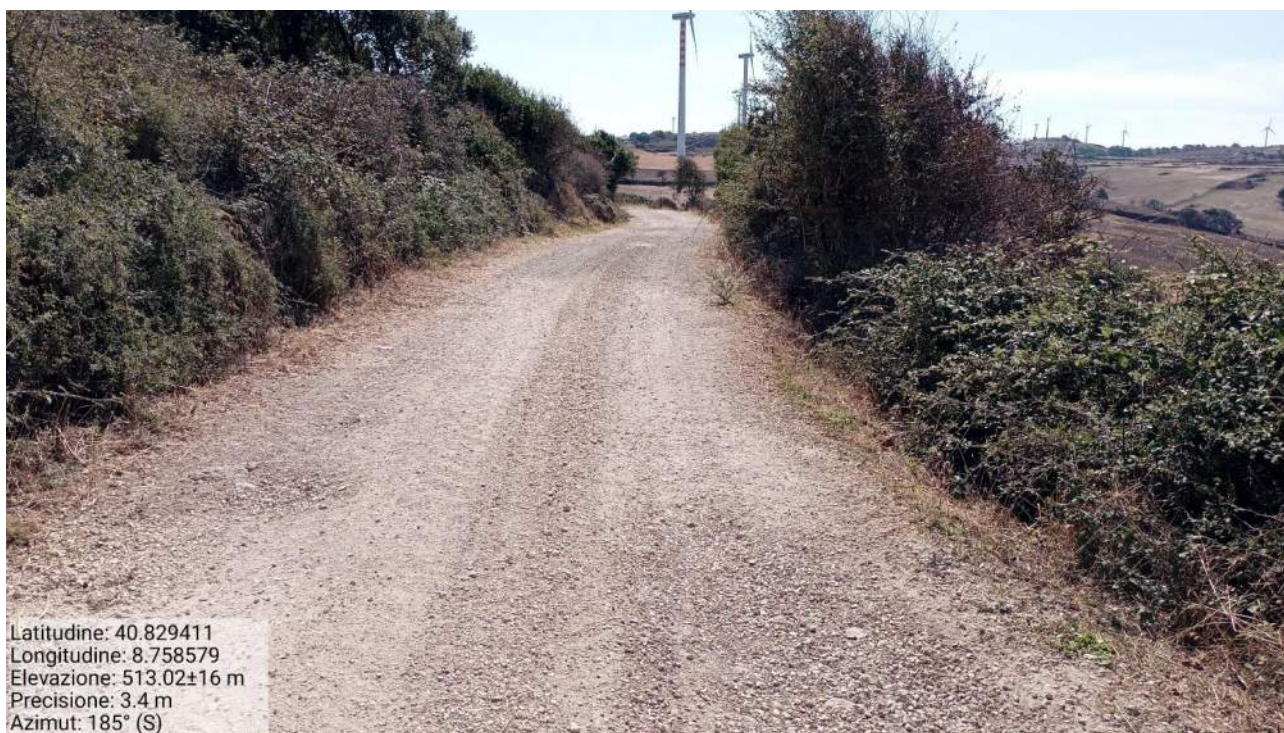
Tratturo campestre di collegamento alla postazione T16 (direzione S)
